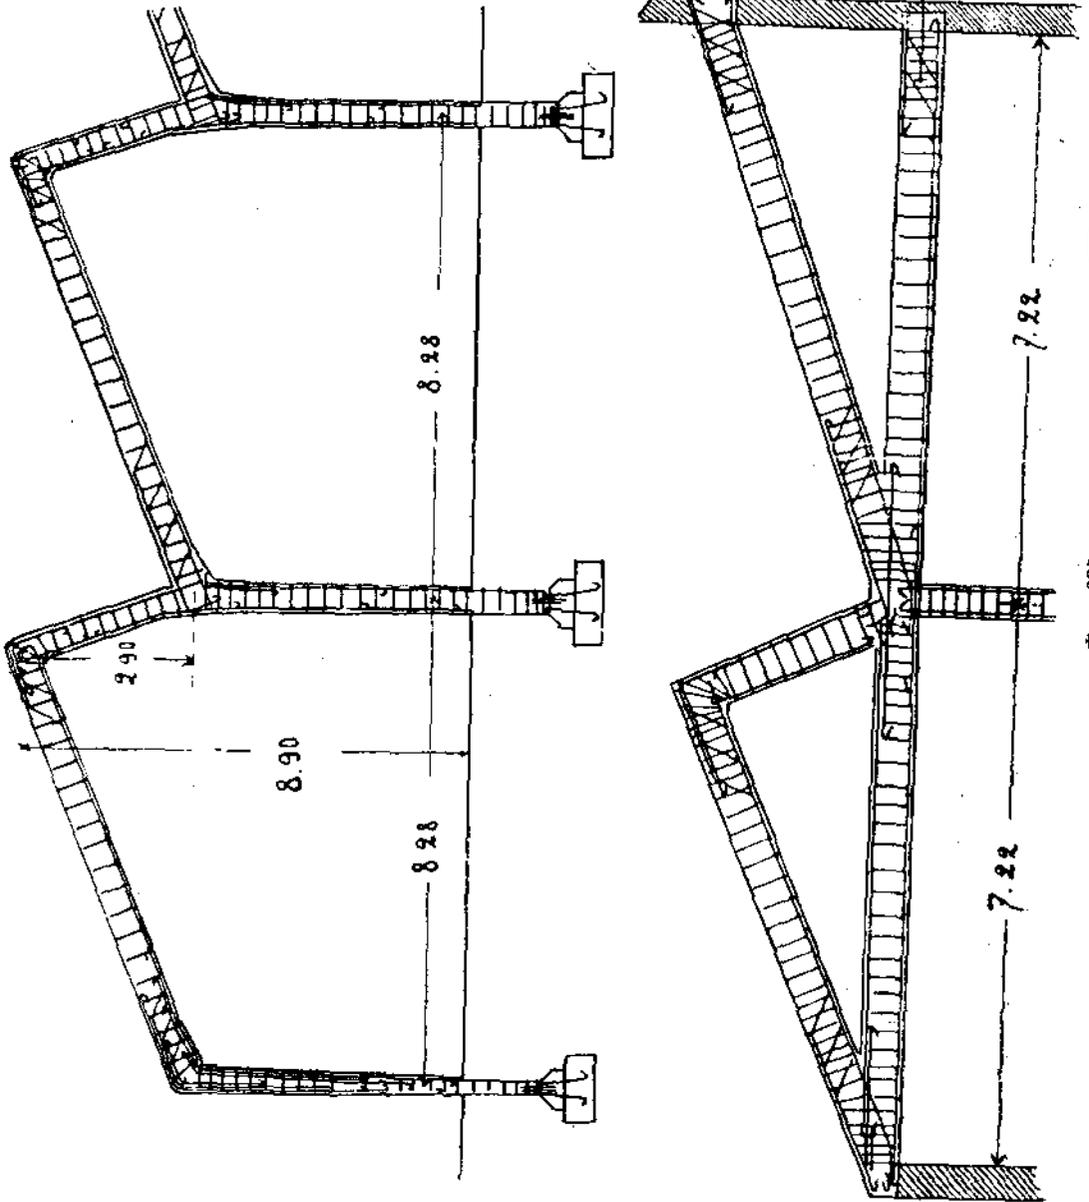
представляет собой шедовое перекрытие конструкторского зала при металлургическом заводе в Дюисбурге, Германия. Фиг. 328—поперечный разрез этого зала; по этому разрезу видно, что здание—одноэтажное на полуподвальном этаже; в первом этаже не имеется никаких стоек внутри зала, и шедовое покрытие перекрывает все помещение при помощи решетчатой металлической фермы с параллельными поясами, установленной в плоскости застекления.
